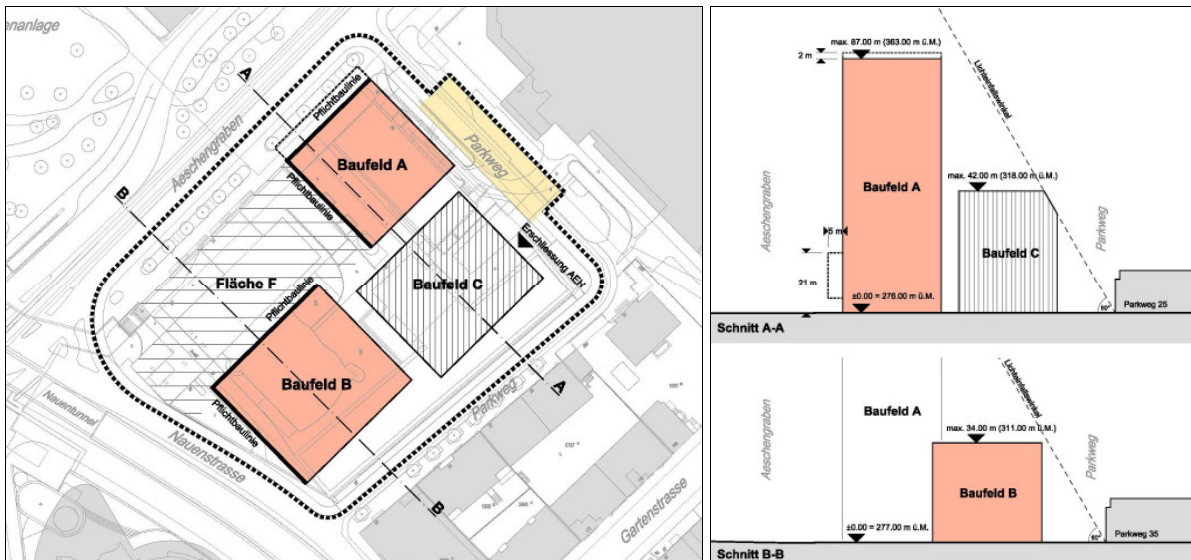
& 14: Neuer Bebauungsplan, Situation und Schnitte. Plan Nr. 13702 (Plan genordet, ohne Massstab)
